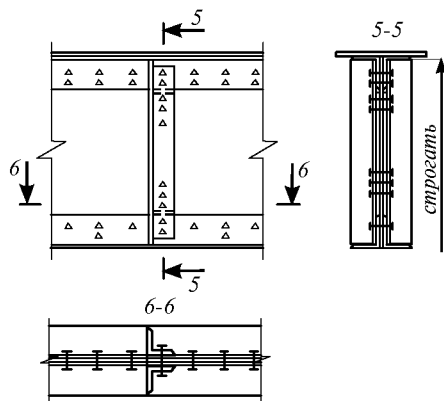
б. Ребра жесткости на подкрановых балках с соединениями на высокопрочных болтах: крепление ребер к стенке балки с прокладкой
